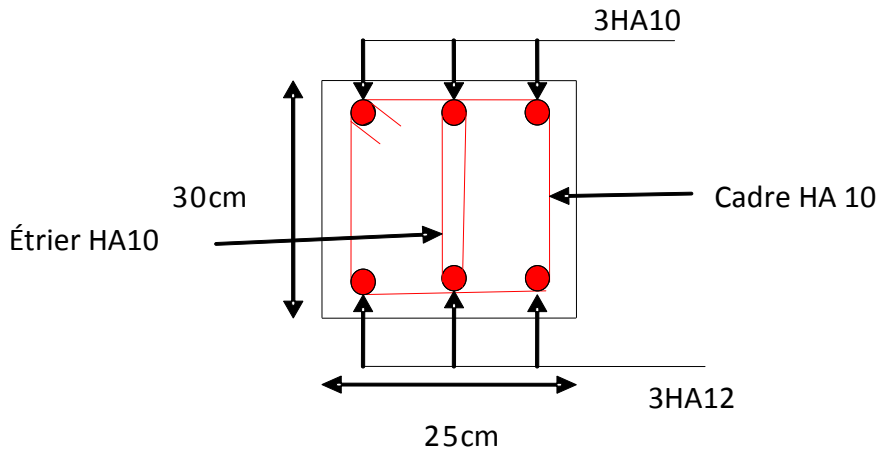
Schéma de ferrailage de la poutre de chaînage.
